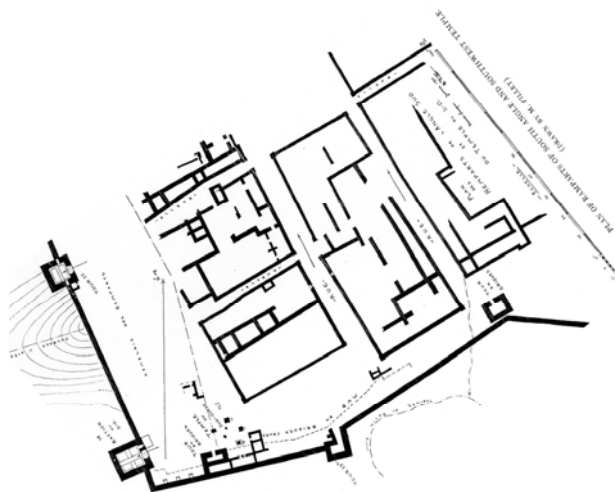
Plan dressé par M. Pillet (janvier 1931).
